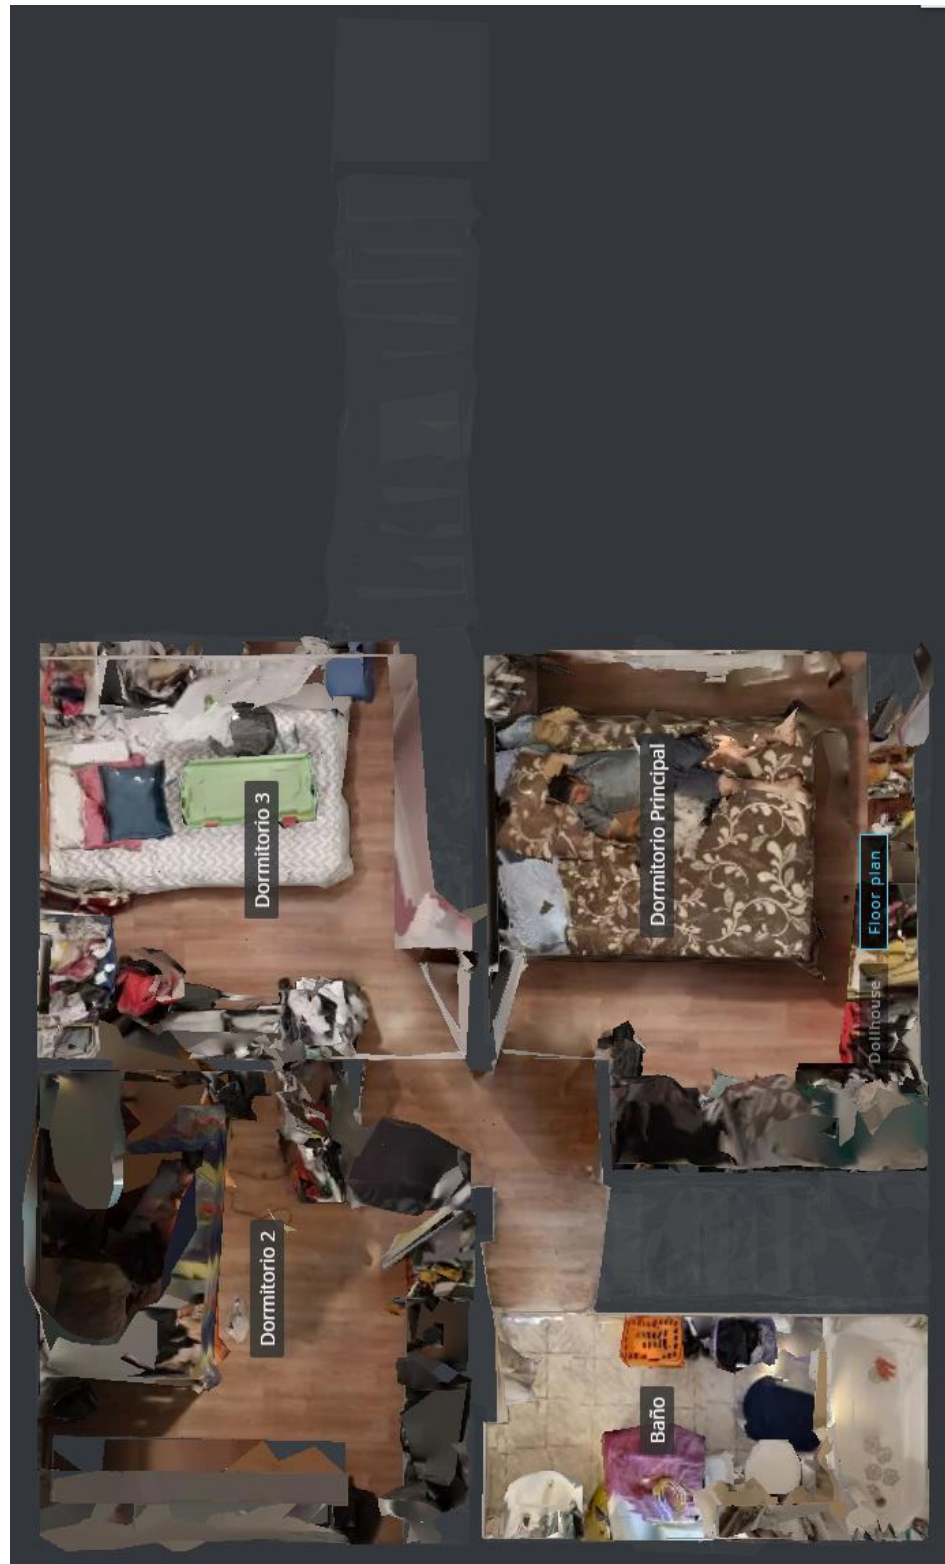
Plano 3D segundo piso vista en planta. Fuente: Elaboración propia a partir de Virtual 3D.
